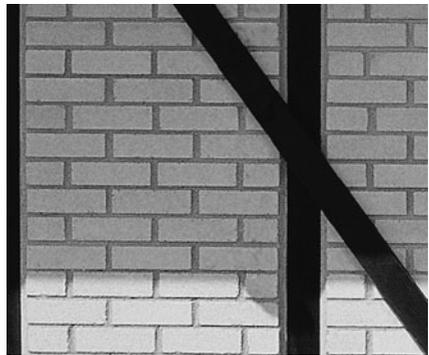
/30: Fachwerk mit Ausfachung aus KS-Sichtmauerwerk
